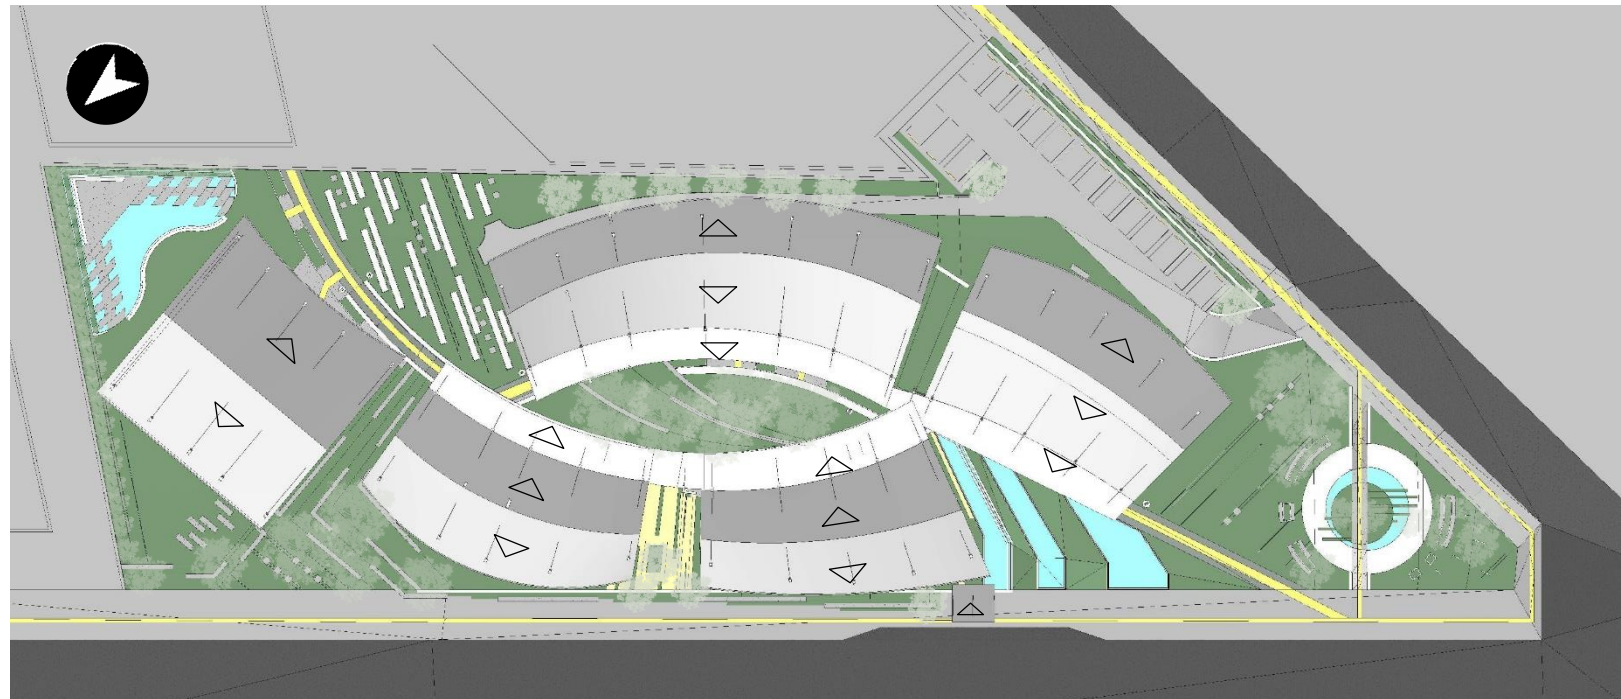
Planta Arquitectónica de Conjunto. Rojas Vargas, A. (2018).
